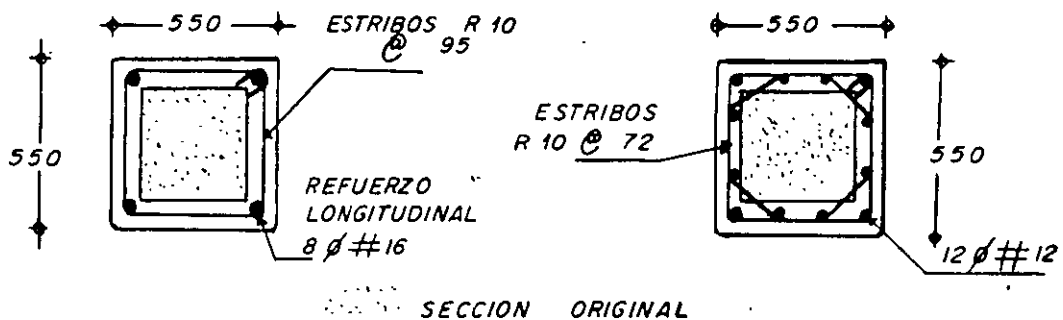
Dimensiones y detalles de las columnas reforzadas con camisas de concreto reforzado que se probaron en la Universidad de Cambridge.
